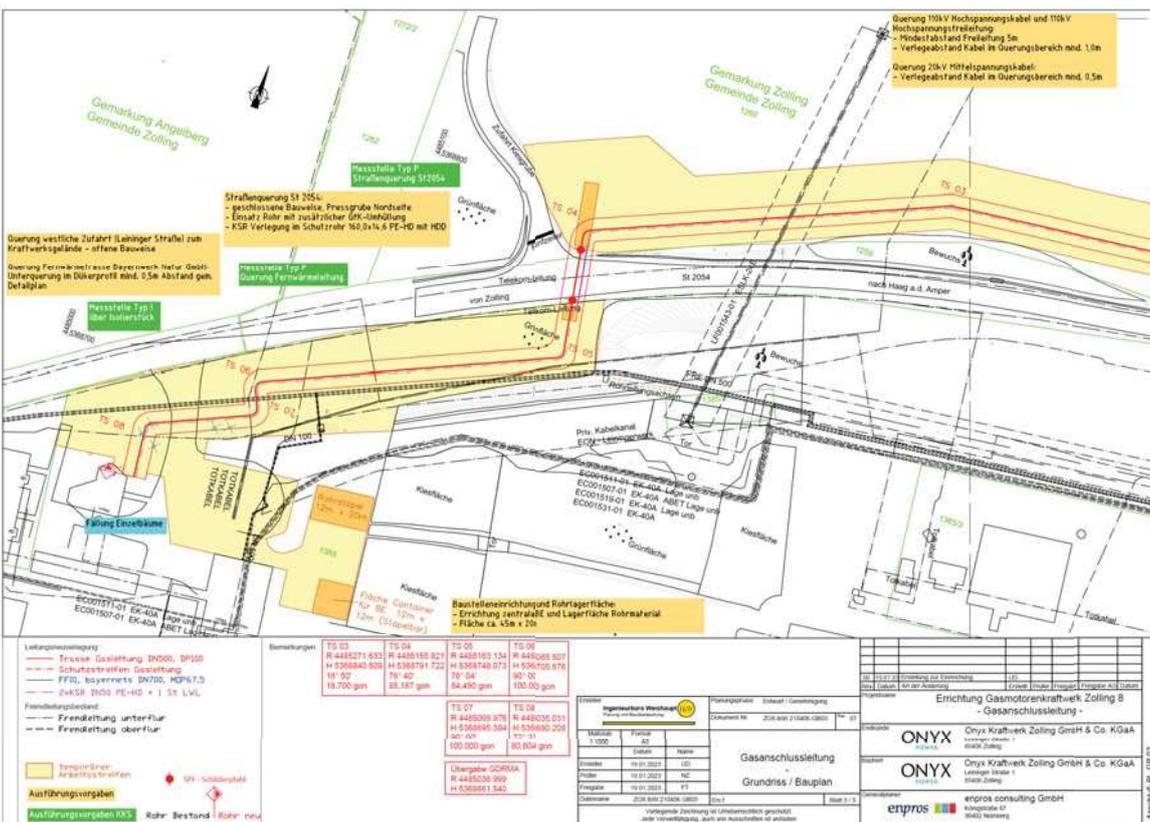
Gasanschlussleitung – Grundrissbauplan Teil 3 [IBW 2023]
